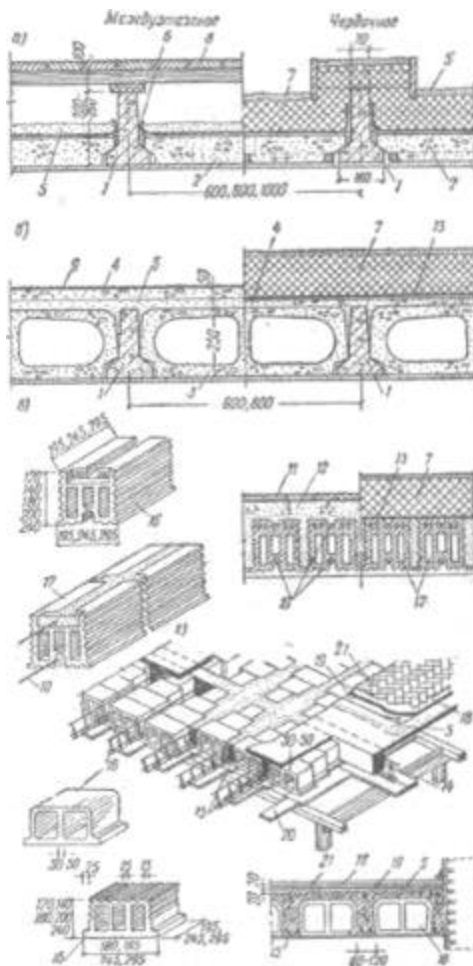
Перекрытия по железобетонным и керамическим балкам
